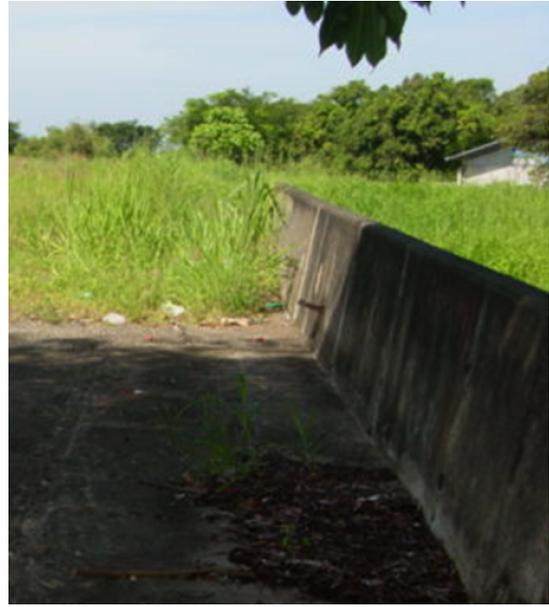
Exposición del sistema vigas-losas prefabricadas.
